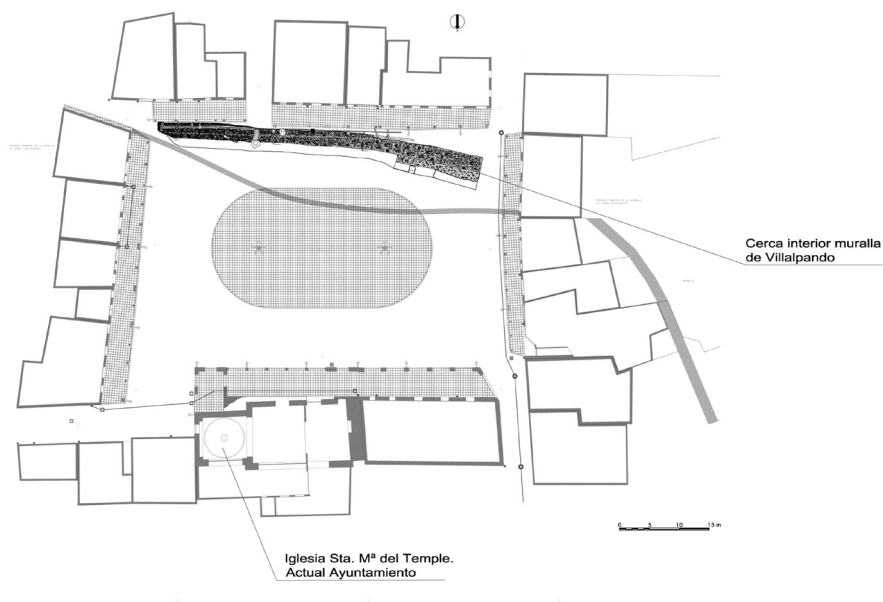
Planta del tramo de muralla detectado en la Plaza Mayor.
